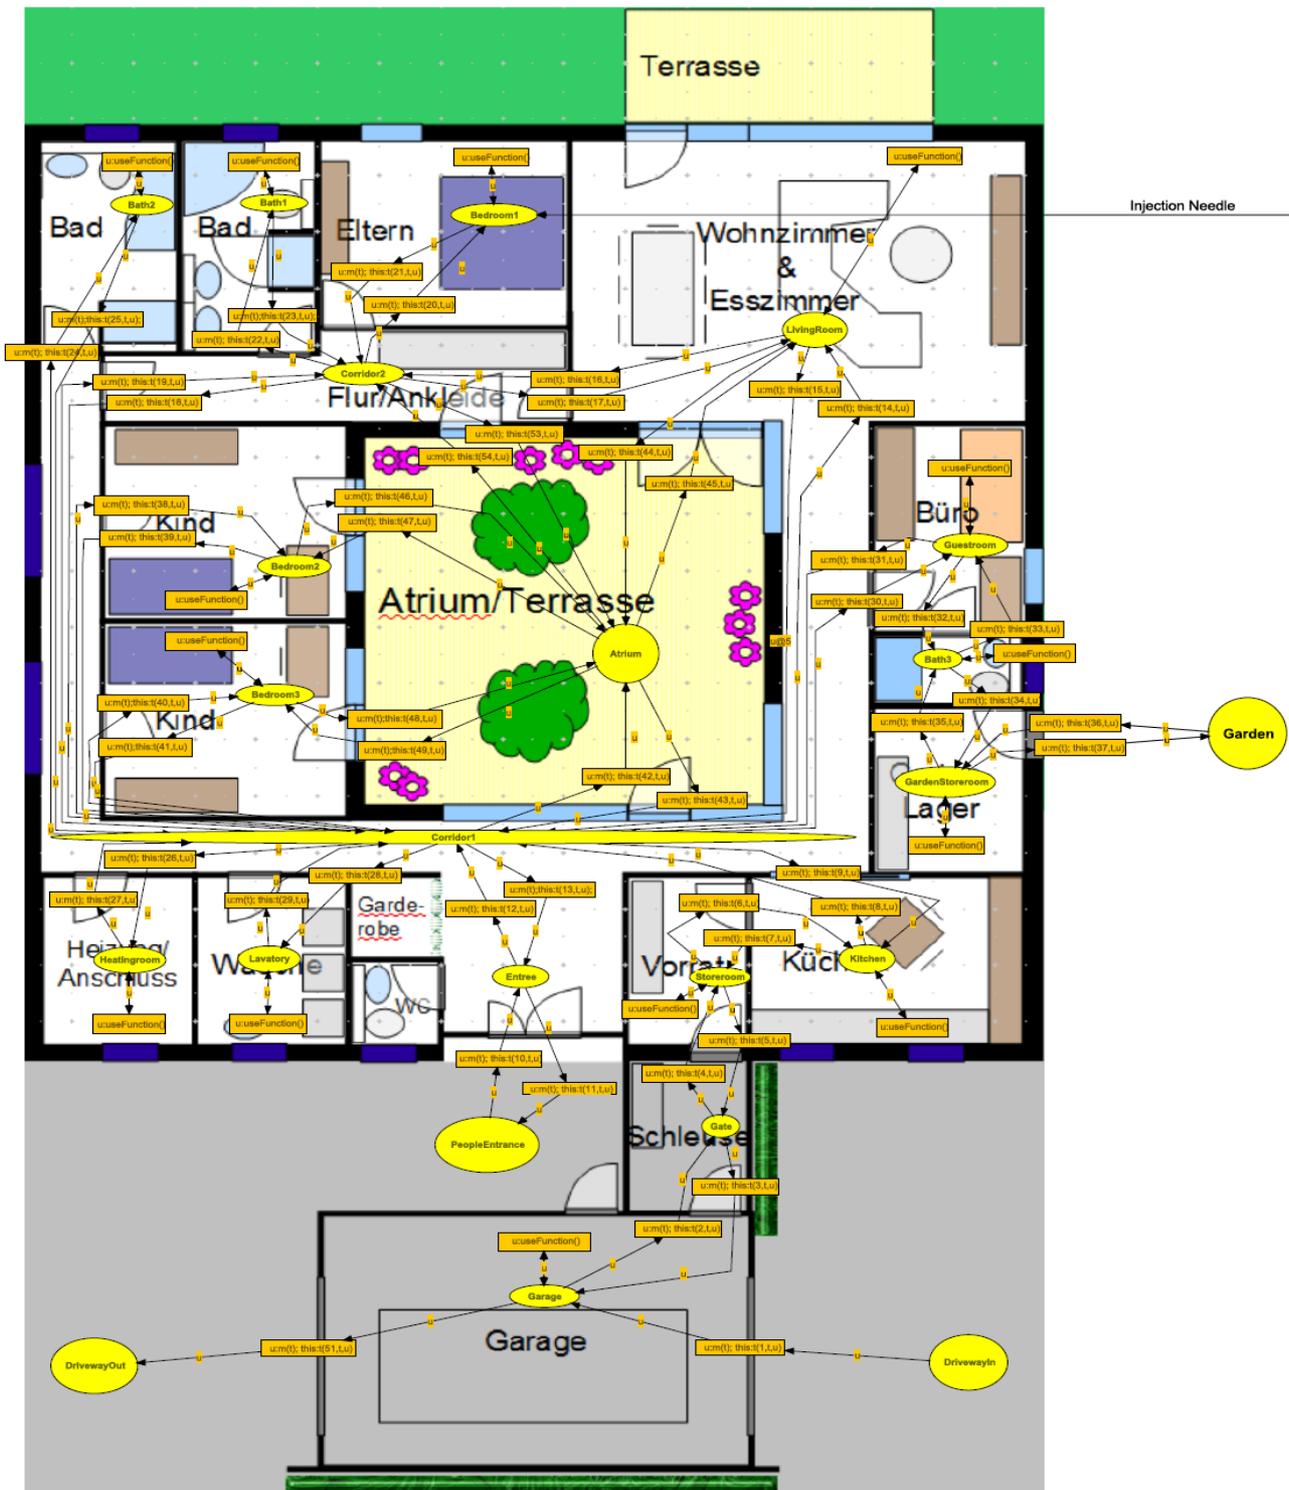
Verwendung im Entwurf eines Individualbaus — Gebäudetopologiemodell und Grundriss
